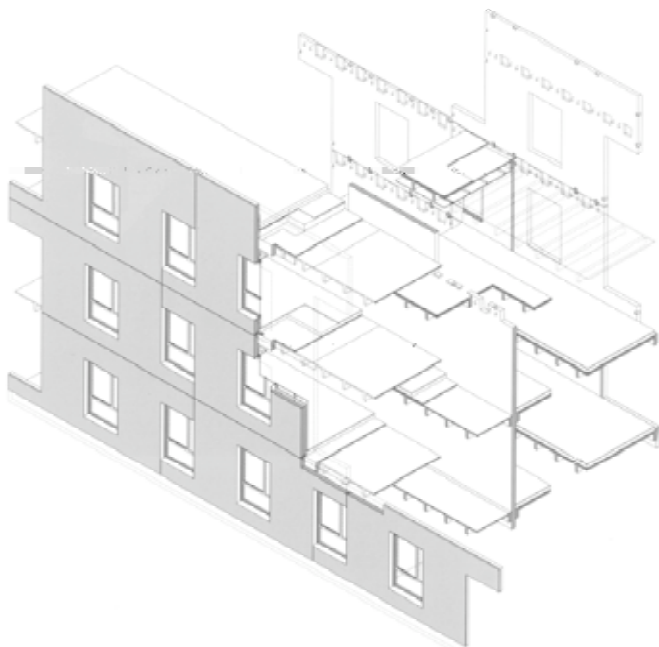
Viviendas de protección oficial. Alcobendas 1995. Prefabricación total INDAG.
